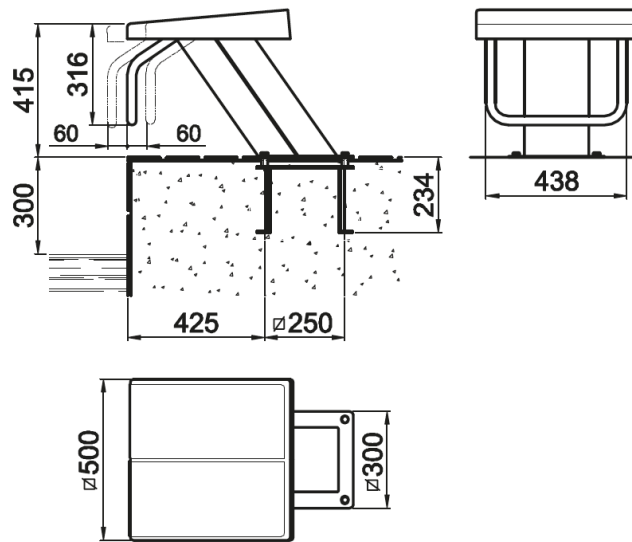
Detalle de plataforma ASTRALPOOL 00145
